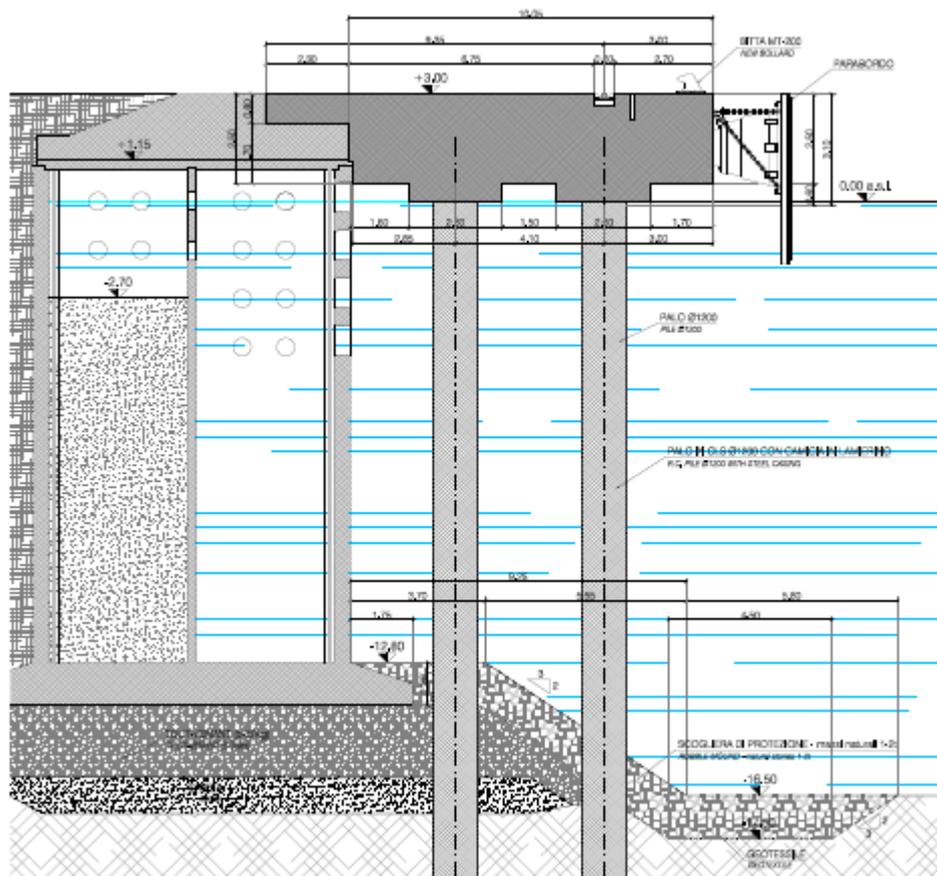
Sezione trasversale tipo della banchina d'ormeggio – progetto
